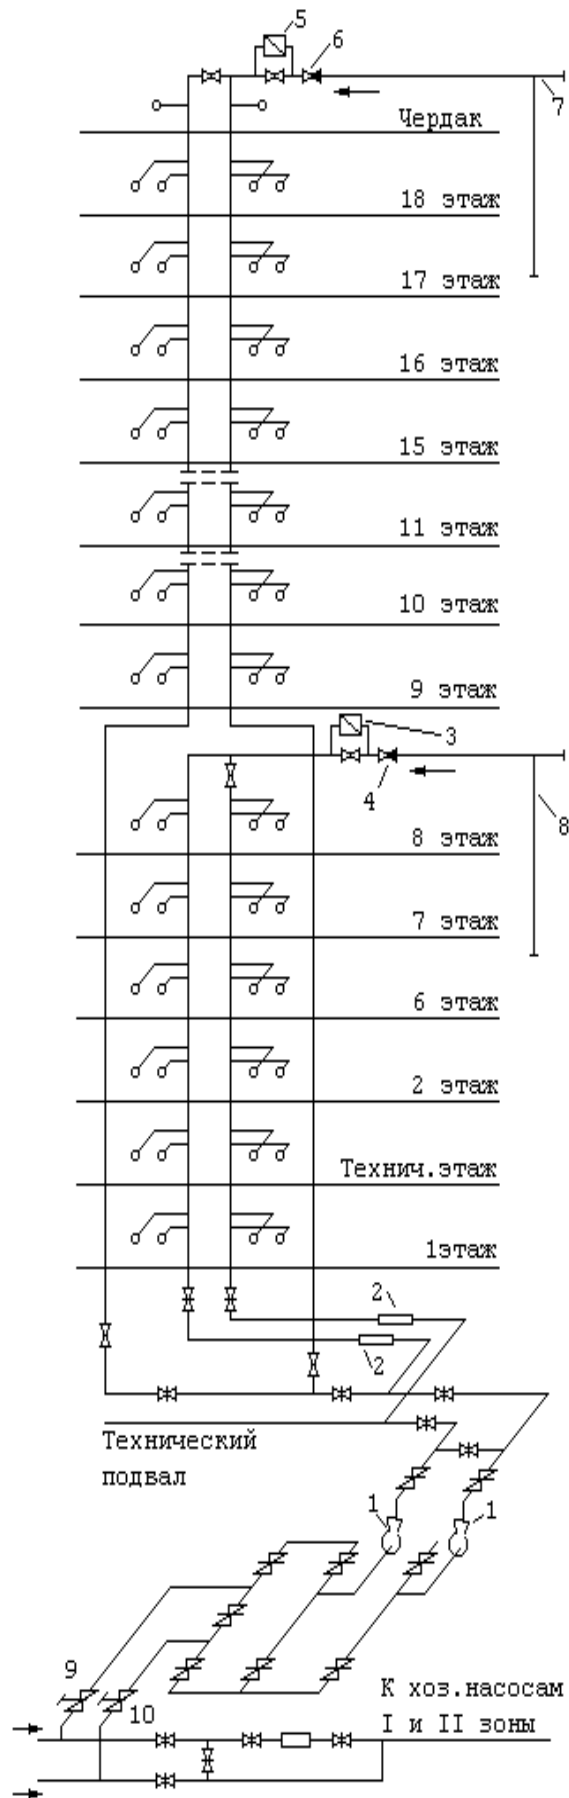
Схема водоснабжения без установки баков 18-этажного здания
